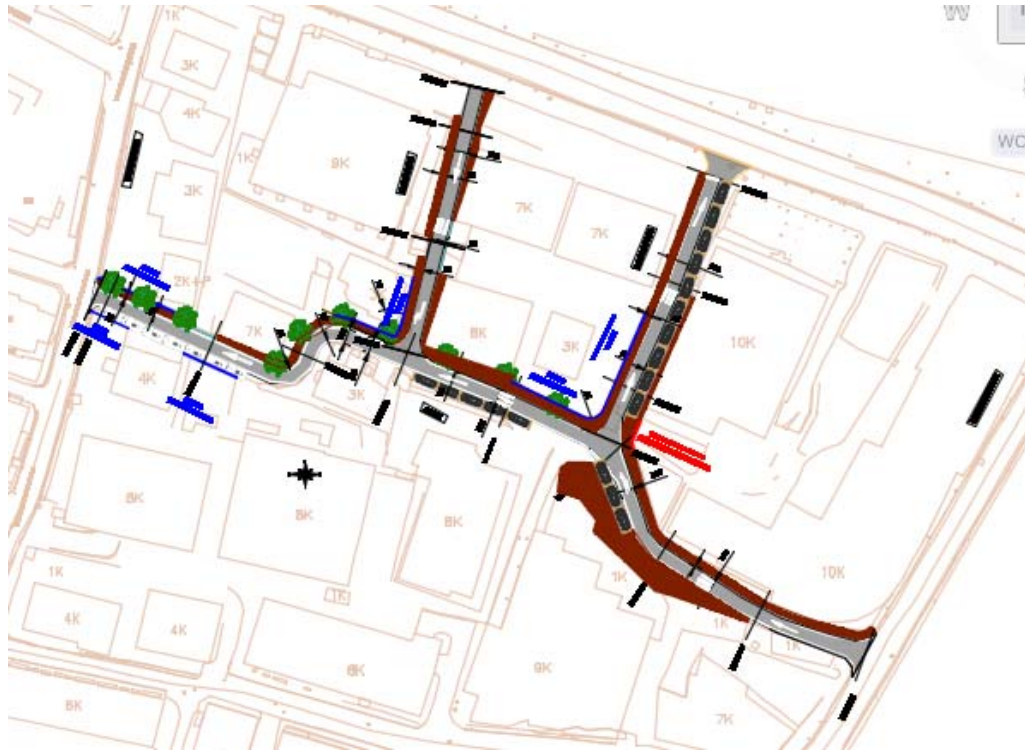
Pamje nga Qarkullimi i ri rrugor dhe planimetritë e rrugëve - Blloku Nr.1
